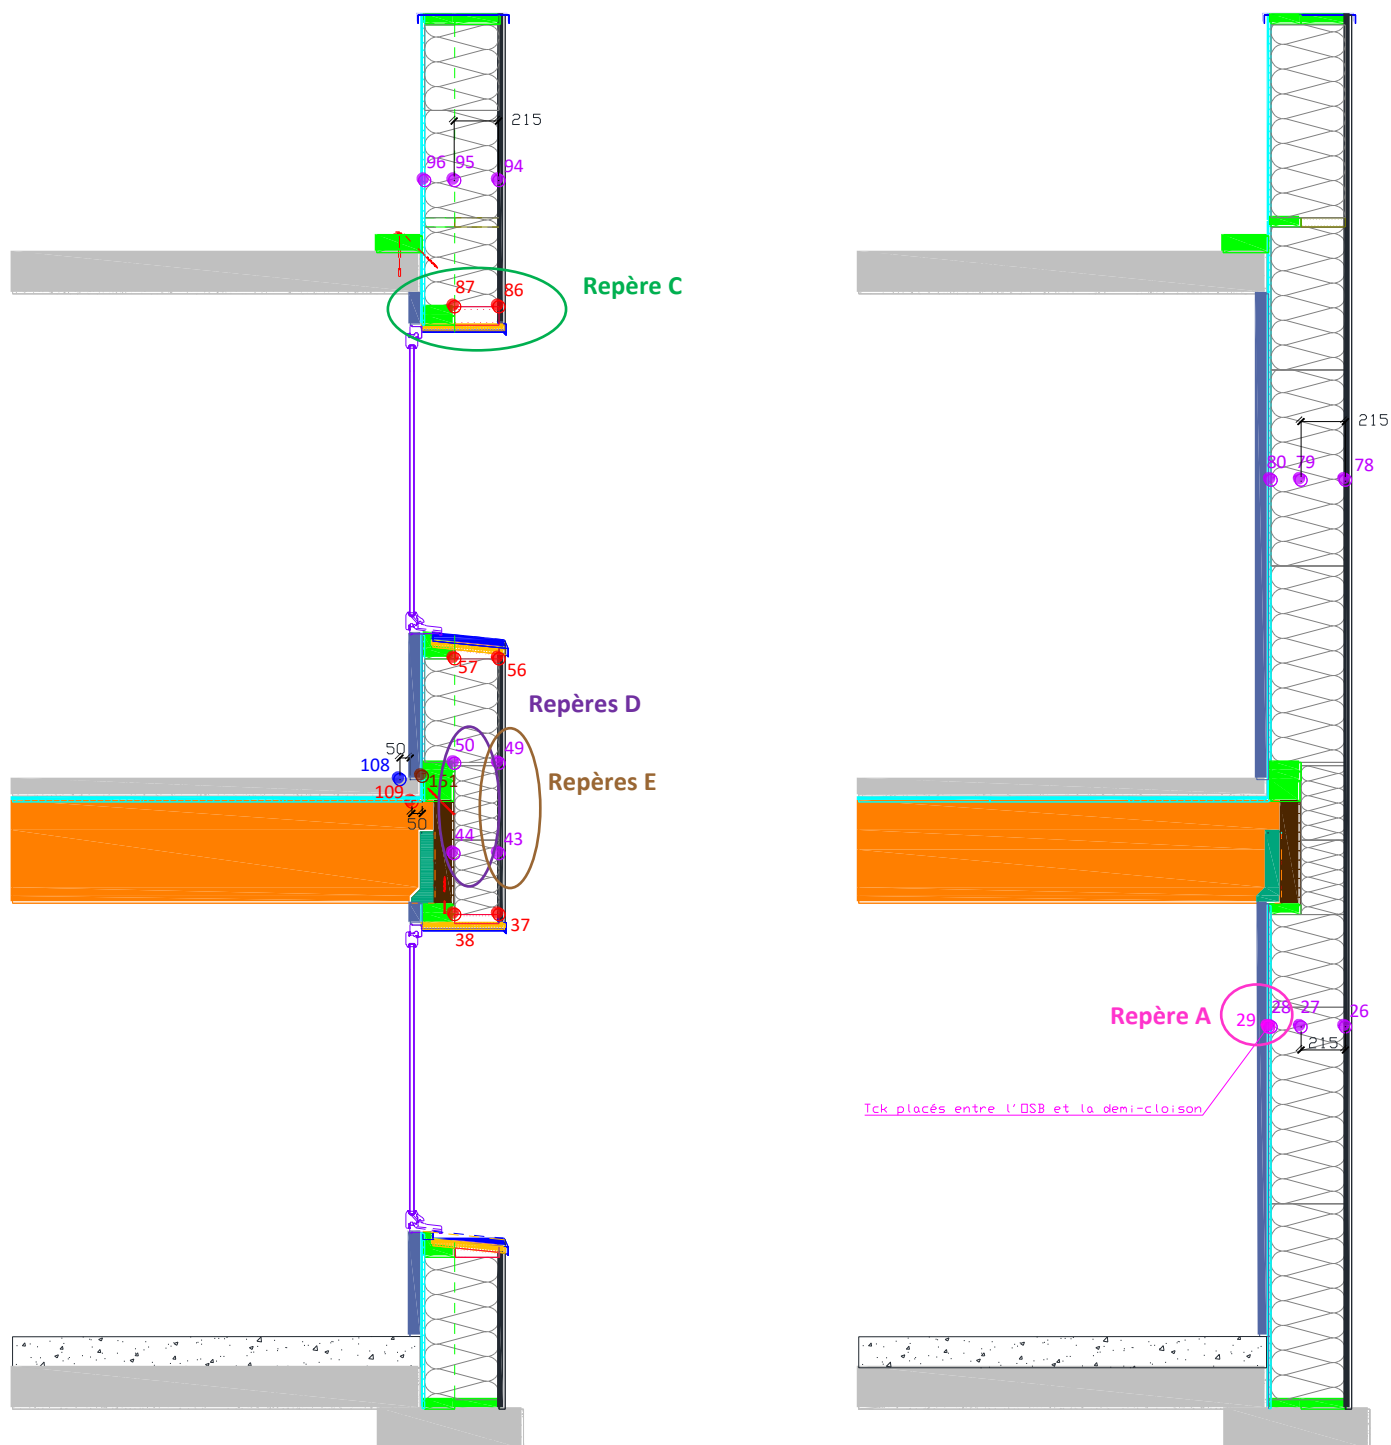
Instrumentation de l'élément de façade - (A gauche) : Coupe E-E - (A droite) : Coupe F-F
